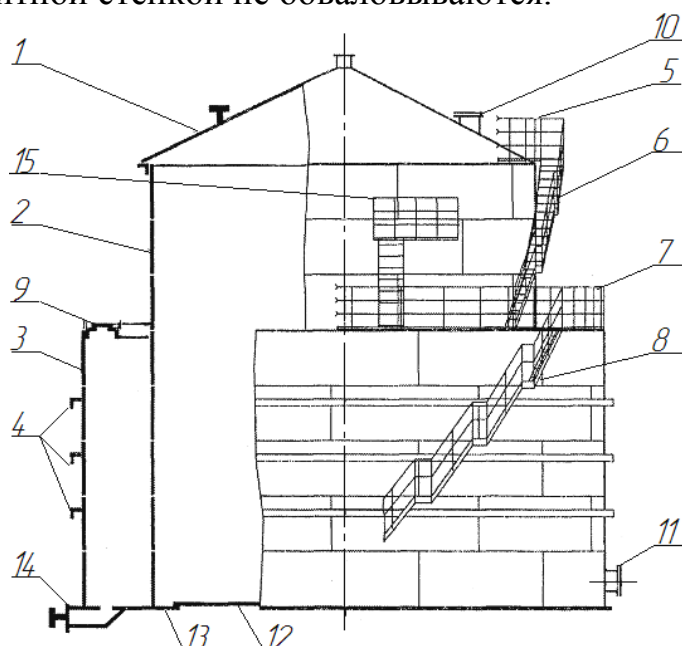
Цилиндрический РВС с защитной стенкой:
